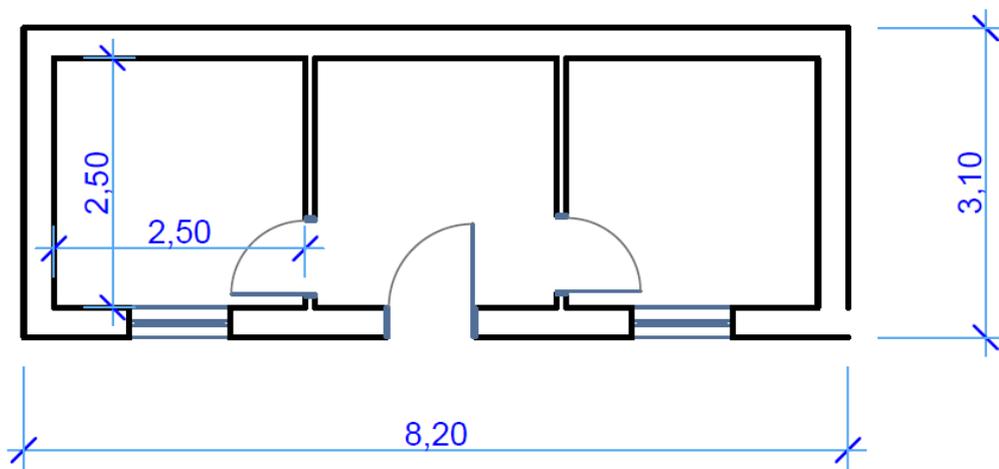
PIANTA INDICATIVA DEL TEST BUILDING
